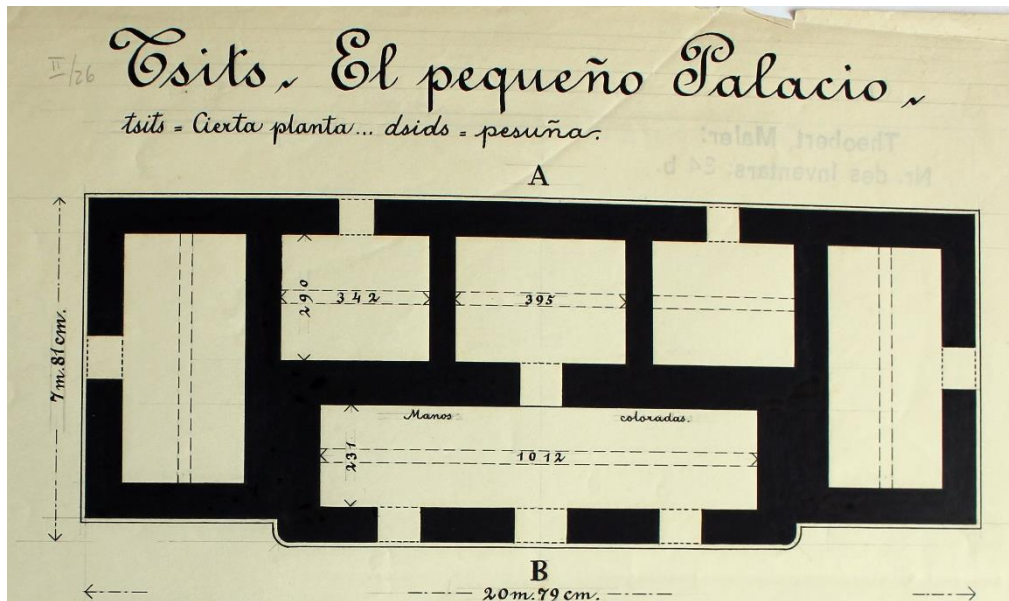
Detalle del plano de Tsits realizado por Maler.
